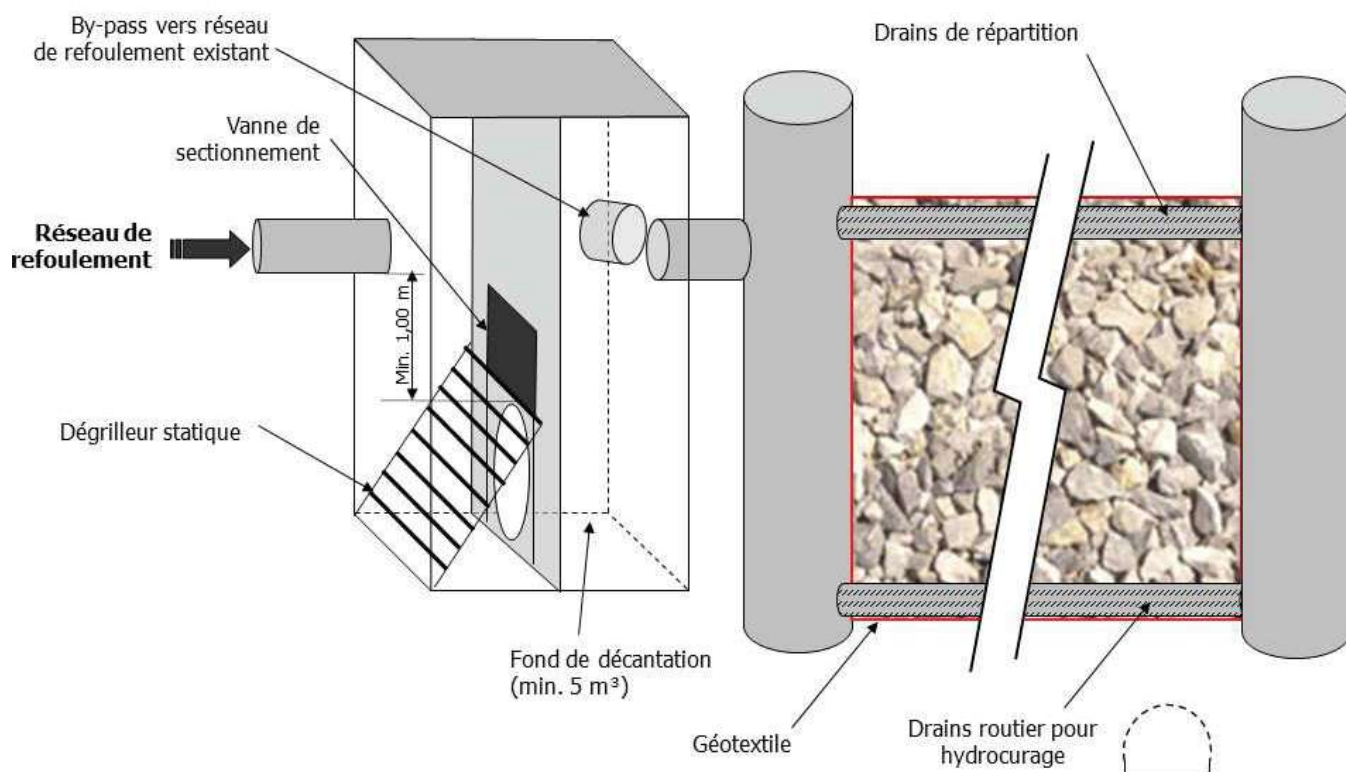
coupe de principe de l'ouvrage d'infiltration avant rejet en mer (coupe transversale)
